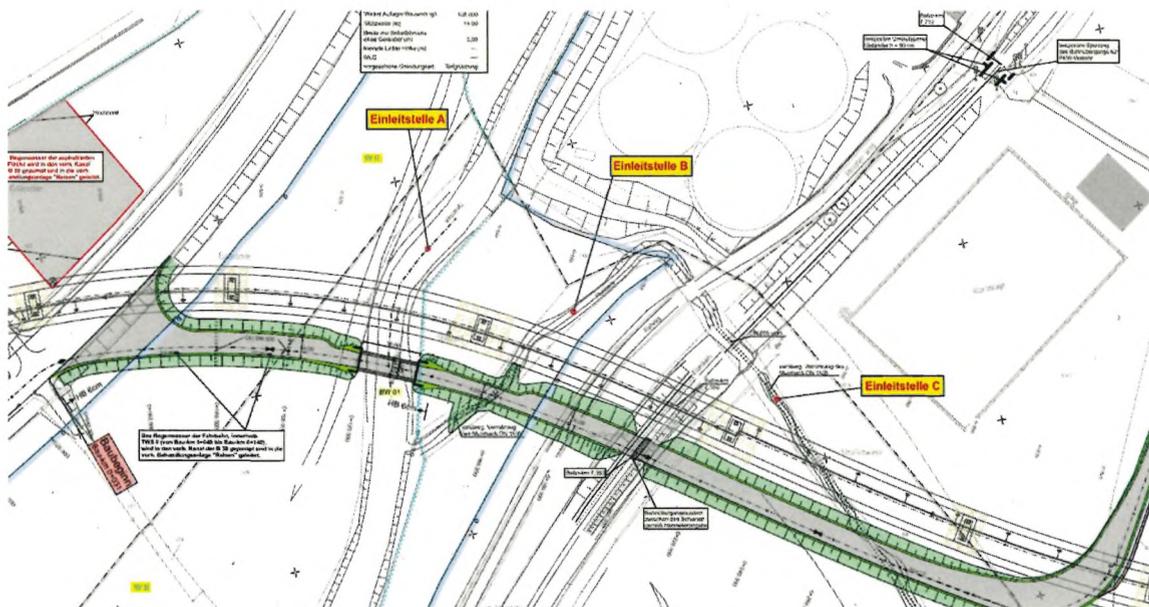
Auszug aus Lageplan 5-1 Baustr. TB Reisen, Hessen Mobil
